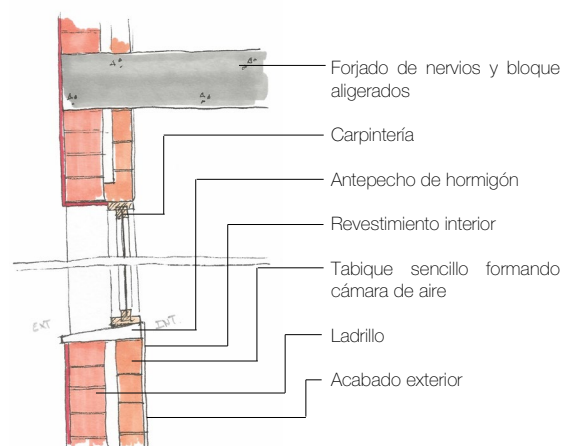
Detalle en sección de carpinterías (autoría propia).
